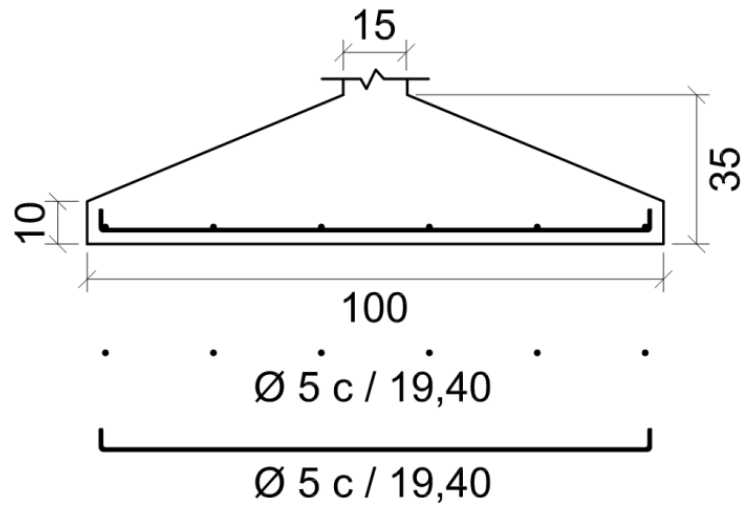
Detalhamento da sapata corrida sem viga de rigidez.
